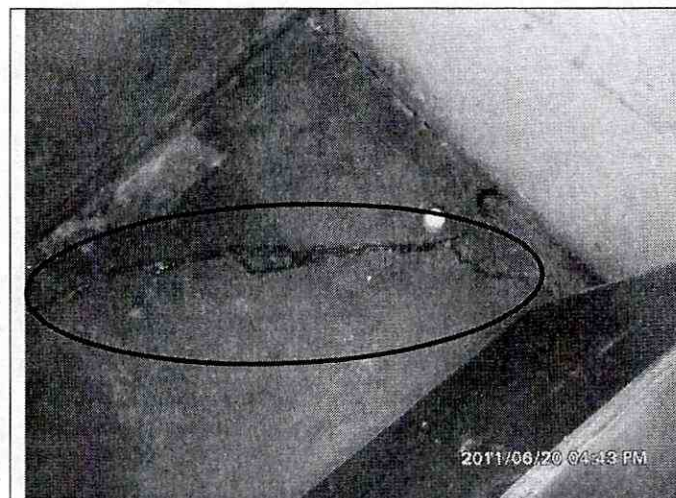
Al costado posterior de la vivienda se observan grietas en el piso causadas posiblemente por asentamientos diferenciales.
